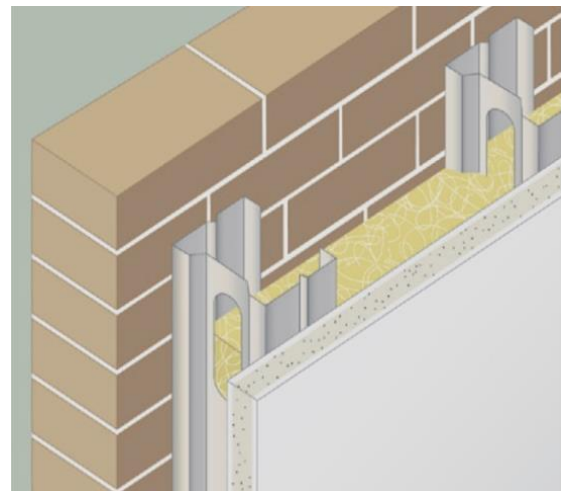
Aislamiento de fachada por el interior. Trasdosado autoportante.
